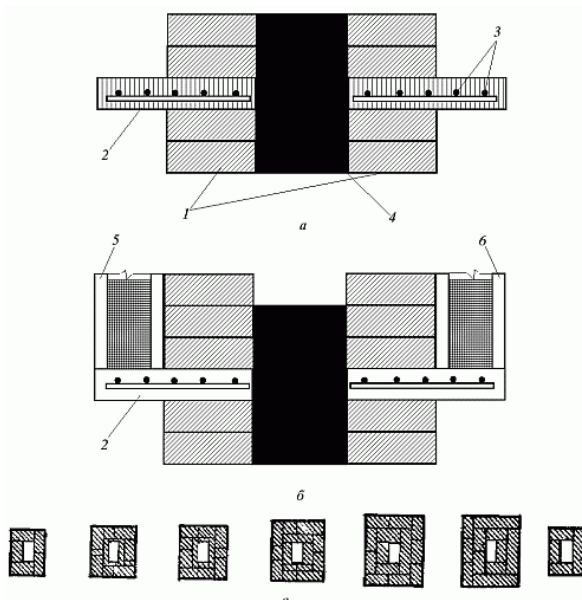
Устройство распушки: а – железобетонная распушка; б – распушка в виде ящика с песком; в – последовательность кладки распушки; 1 – печная кладка; 2 – бетон; 3 – арматура; 4 – дымоход; 5 – стенки ящика; 6 – песок
